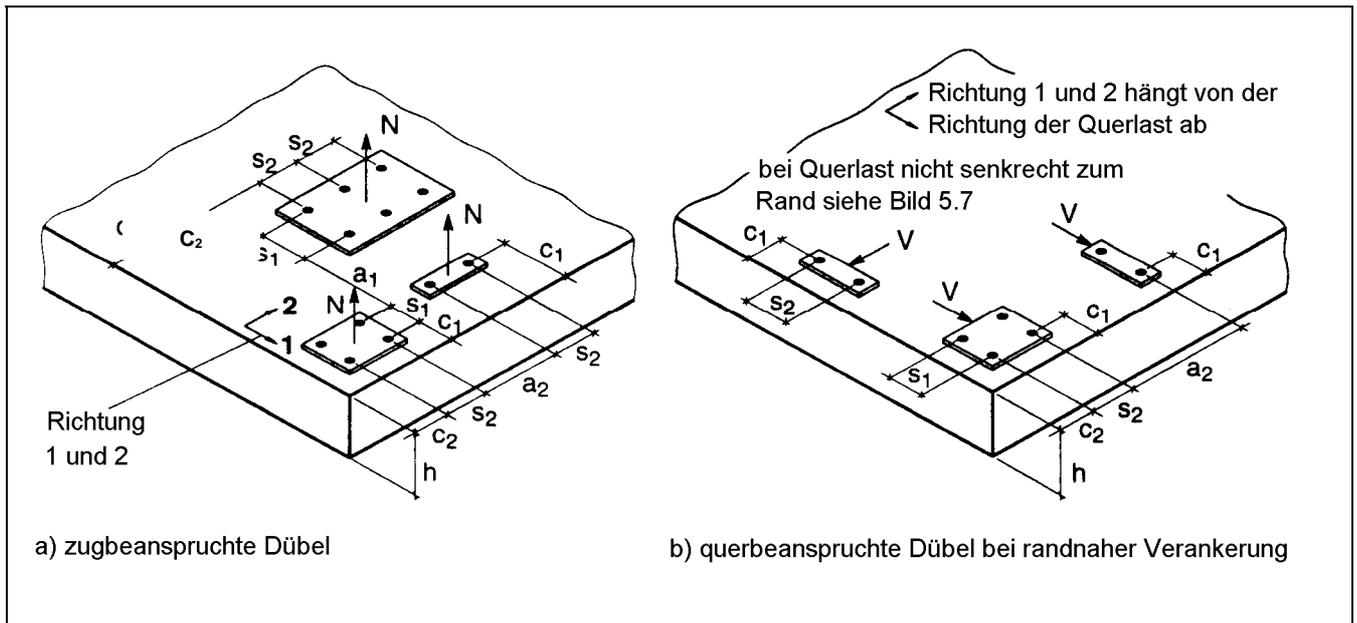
Betonbauteil, Dübelachs- und -randabstände
